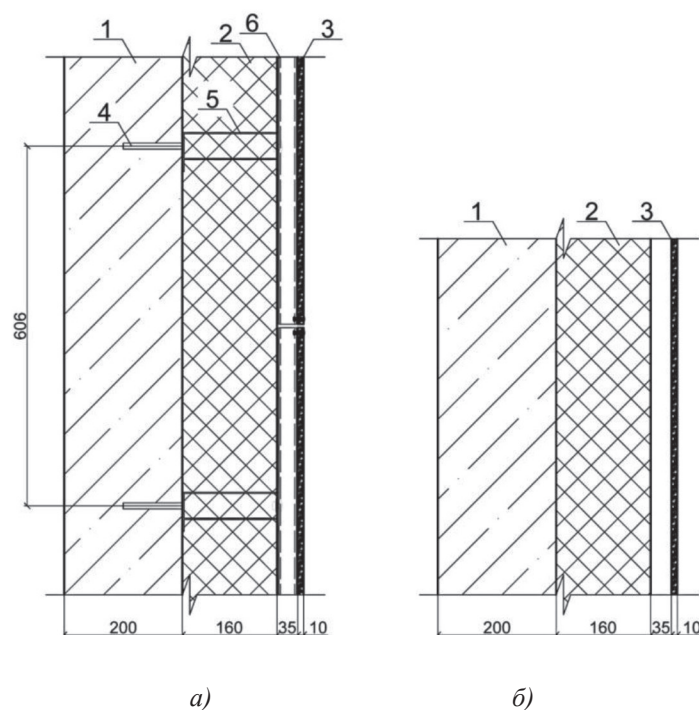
Строительные узлы в двух видах: 1 – железобетонная плита; 2 – утеплитель минераловатный; 3 – фасадная плитка; 4 – дюбель фасадный с оцинкованным шурупом; 5 – кронштейн несущий; 6 – несущий вертикальный профиль
